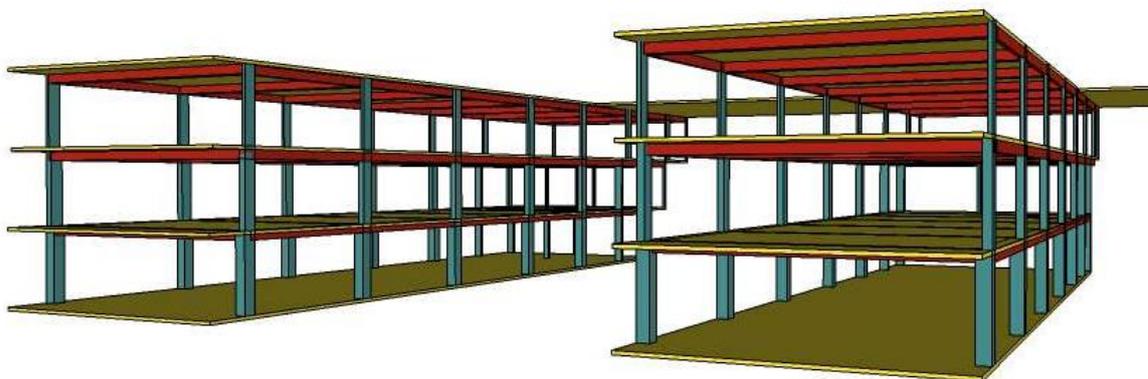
Elementos Estruturais pavimento do subsolo, inferior e térreo.
